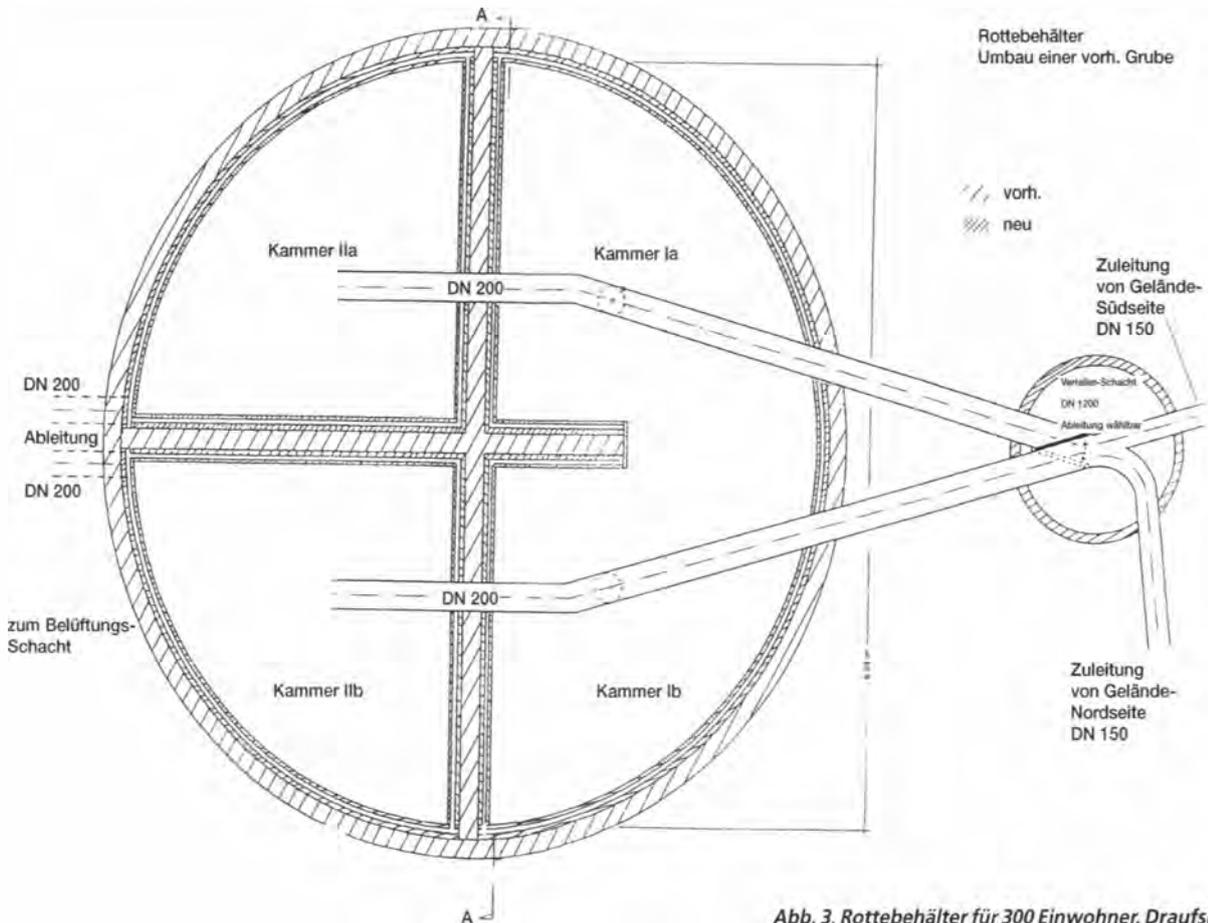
Rottebehälter für 300 Einwohner, Draufsicht.
